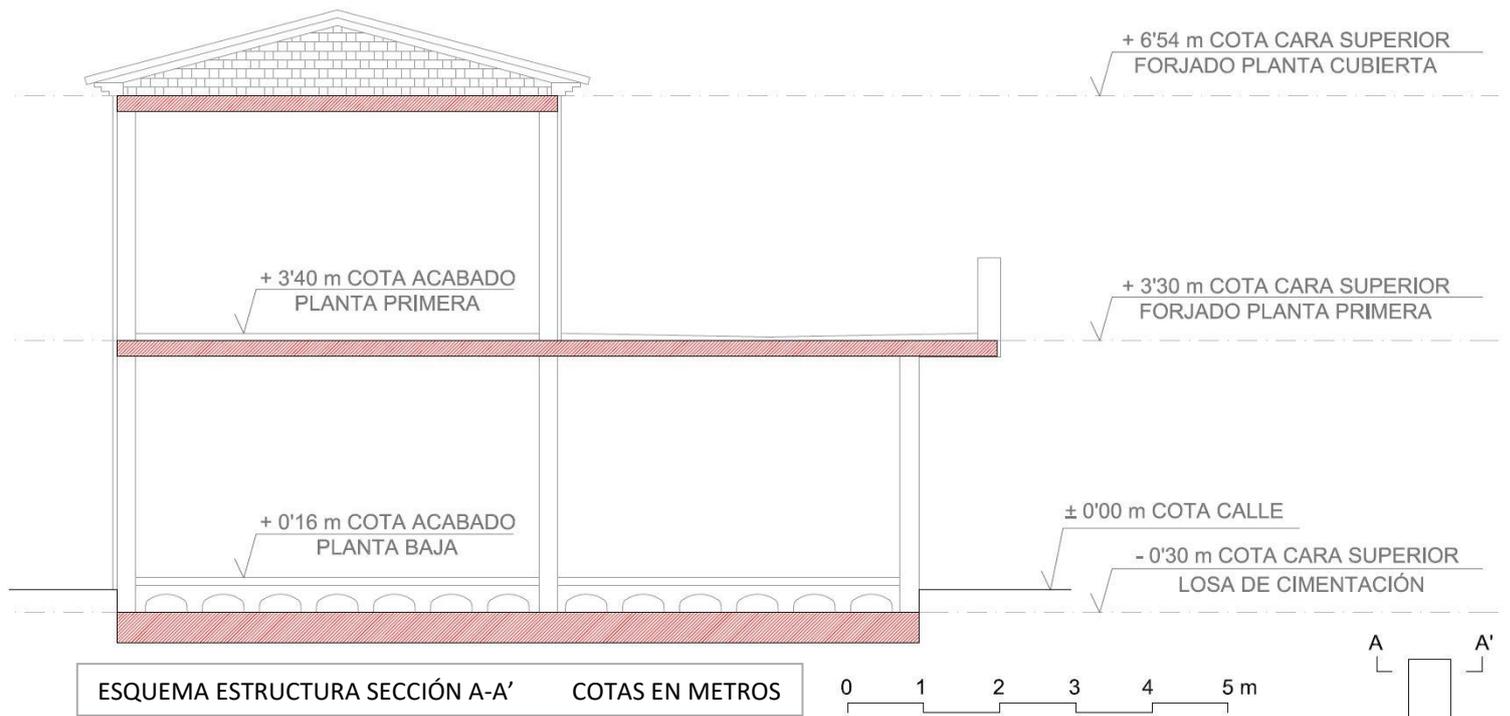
05. Plano esquema estructura sección transversal A - A', elaboración propia
